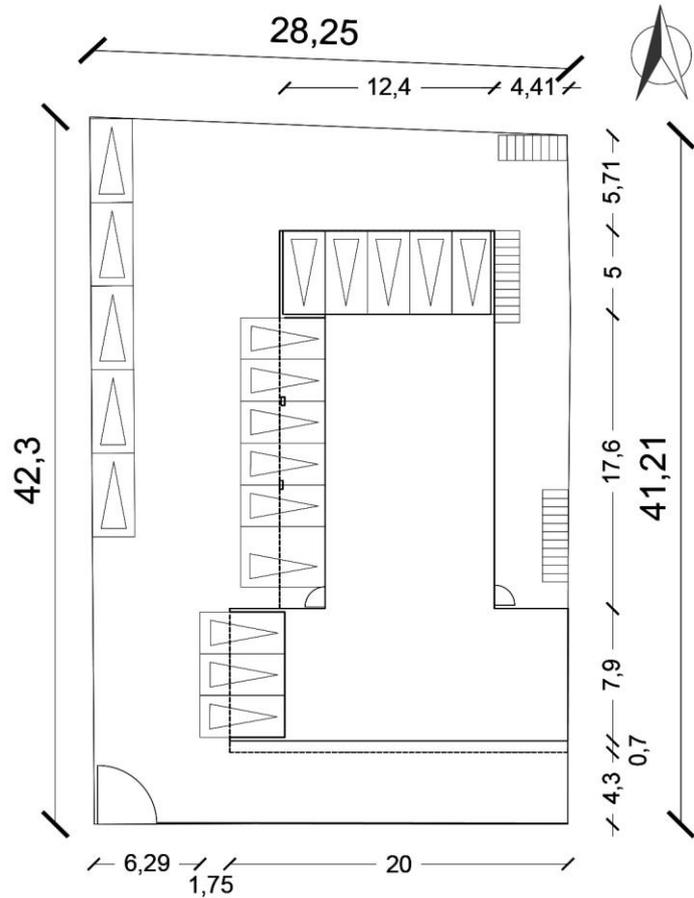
Planta de patio propuesta Conchalí. Escala 1:400. Elaboración propia.
